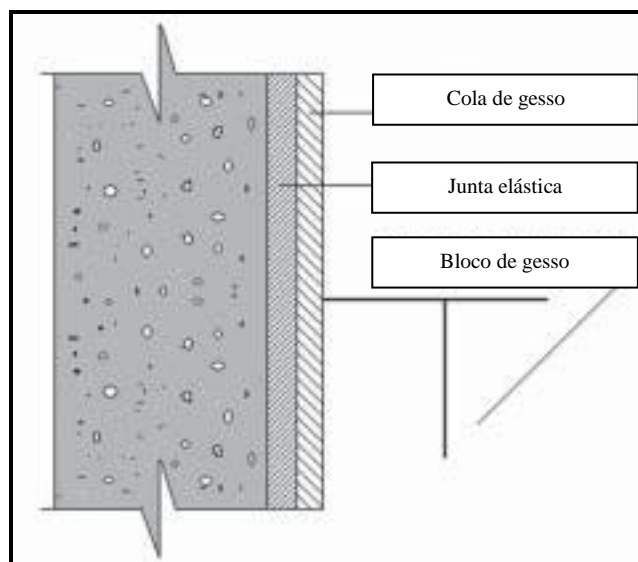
Detalhe da fixação entre a vedação e a estrutura de concreto (ATEDY, 2009)
